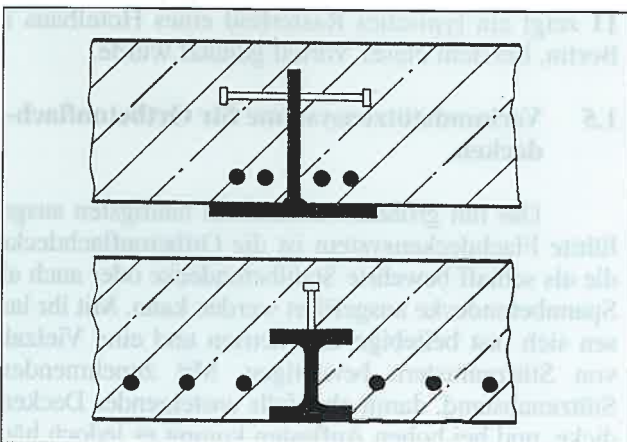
Mögliche Anordnung der Stahlprofile im Deckenquerschnitt
